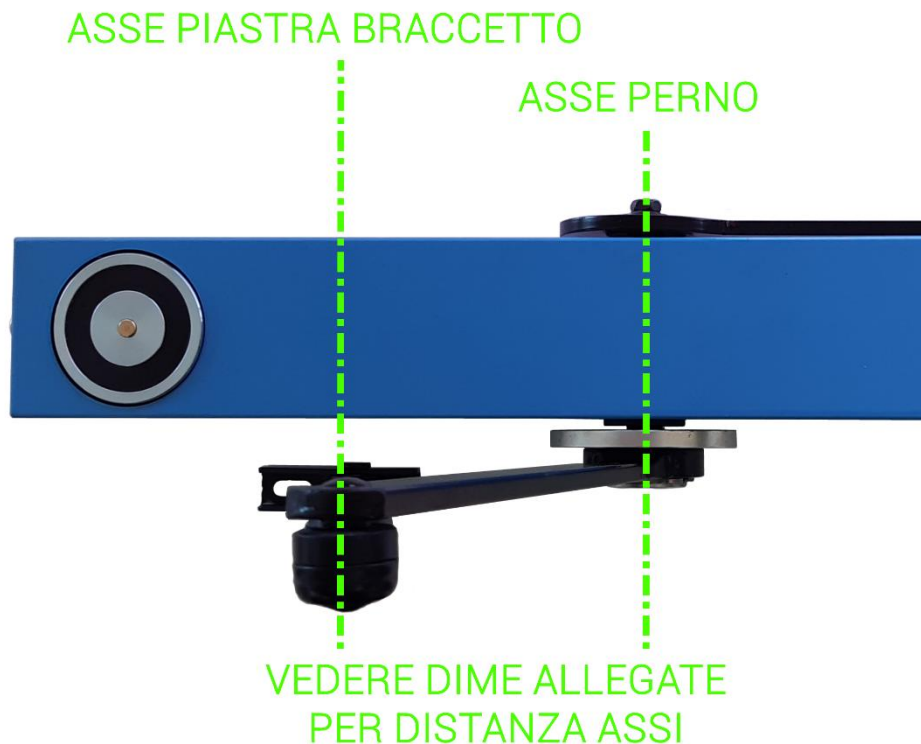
Posizionamento dell'asse della piastra di ancoraggio del braccetto rispetto all'asse perno (vista dall'alto)
